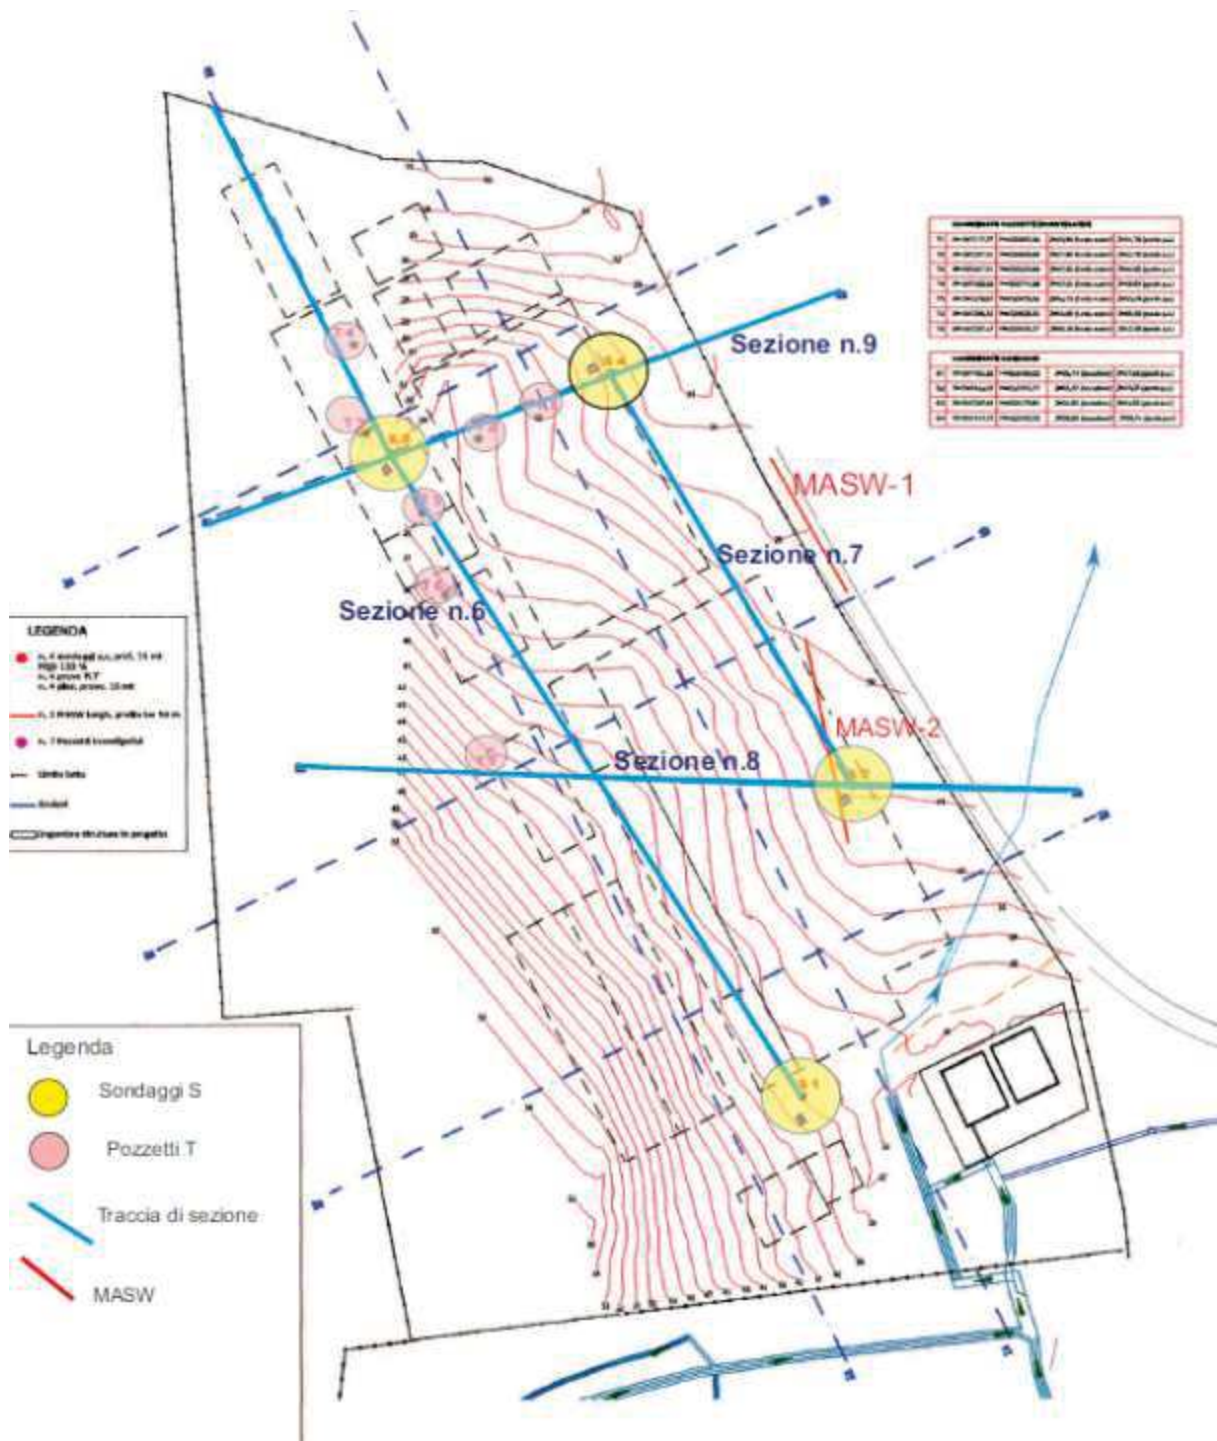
Planimetria con ubicazione delle sezioni geolitologiche
